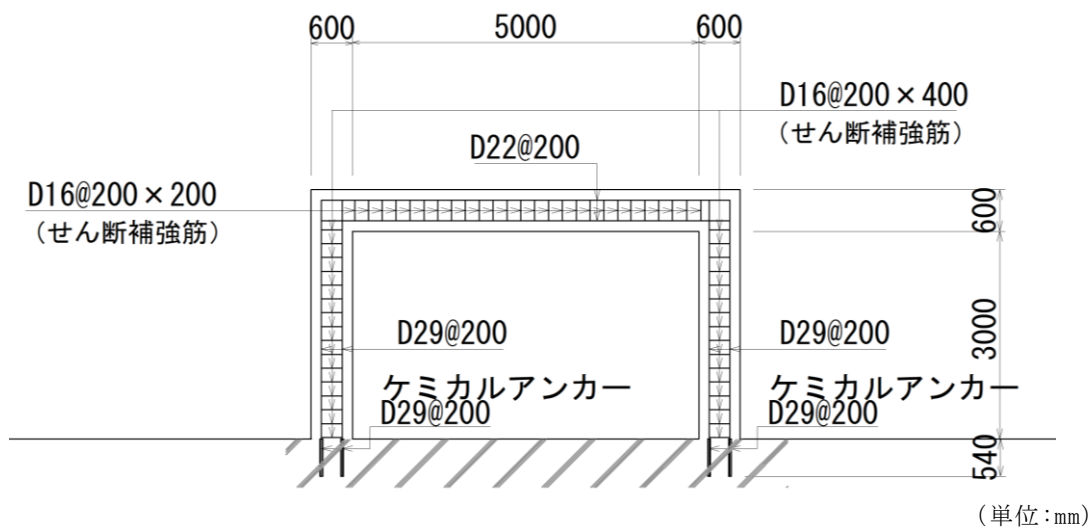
ボンベ庫 概略配筋図 (B-B 断面)
